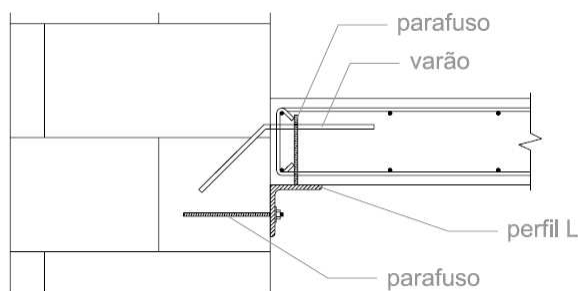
Apoio da laje de betão através de perfil L.
